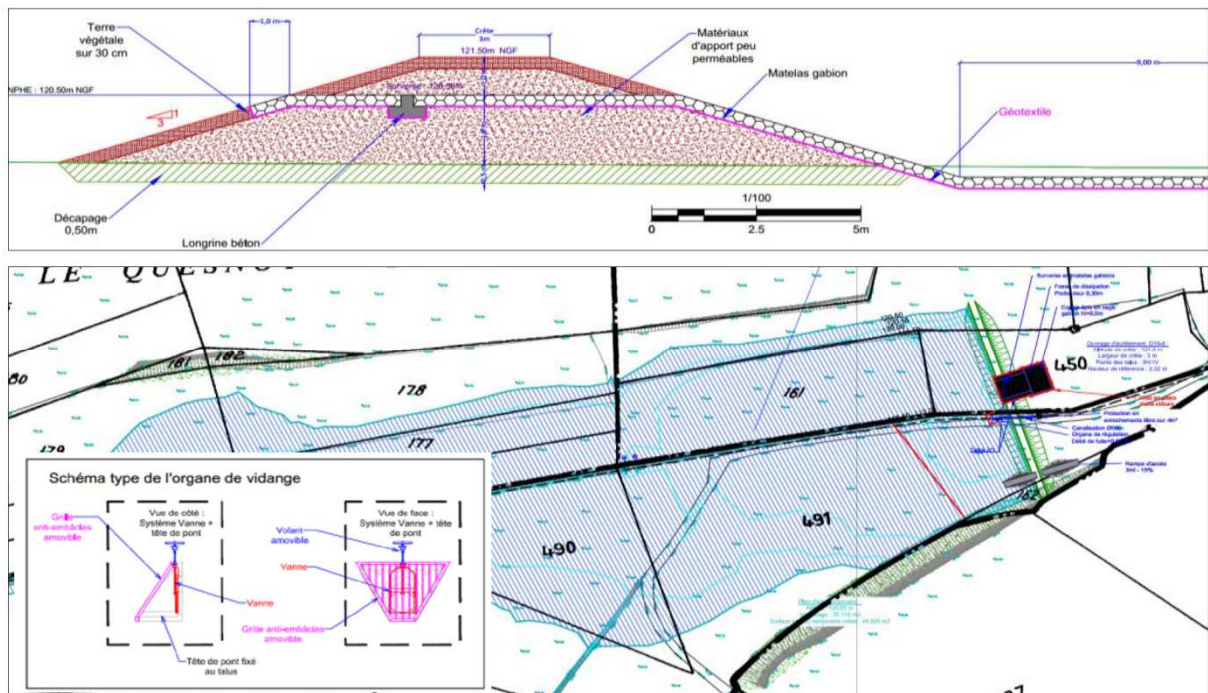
Extrait du plan de masse – Ouvrage D19-8
